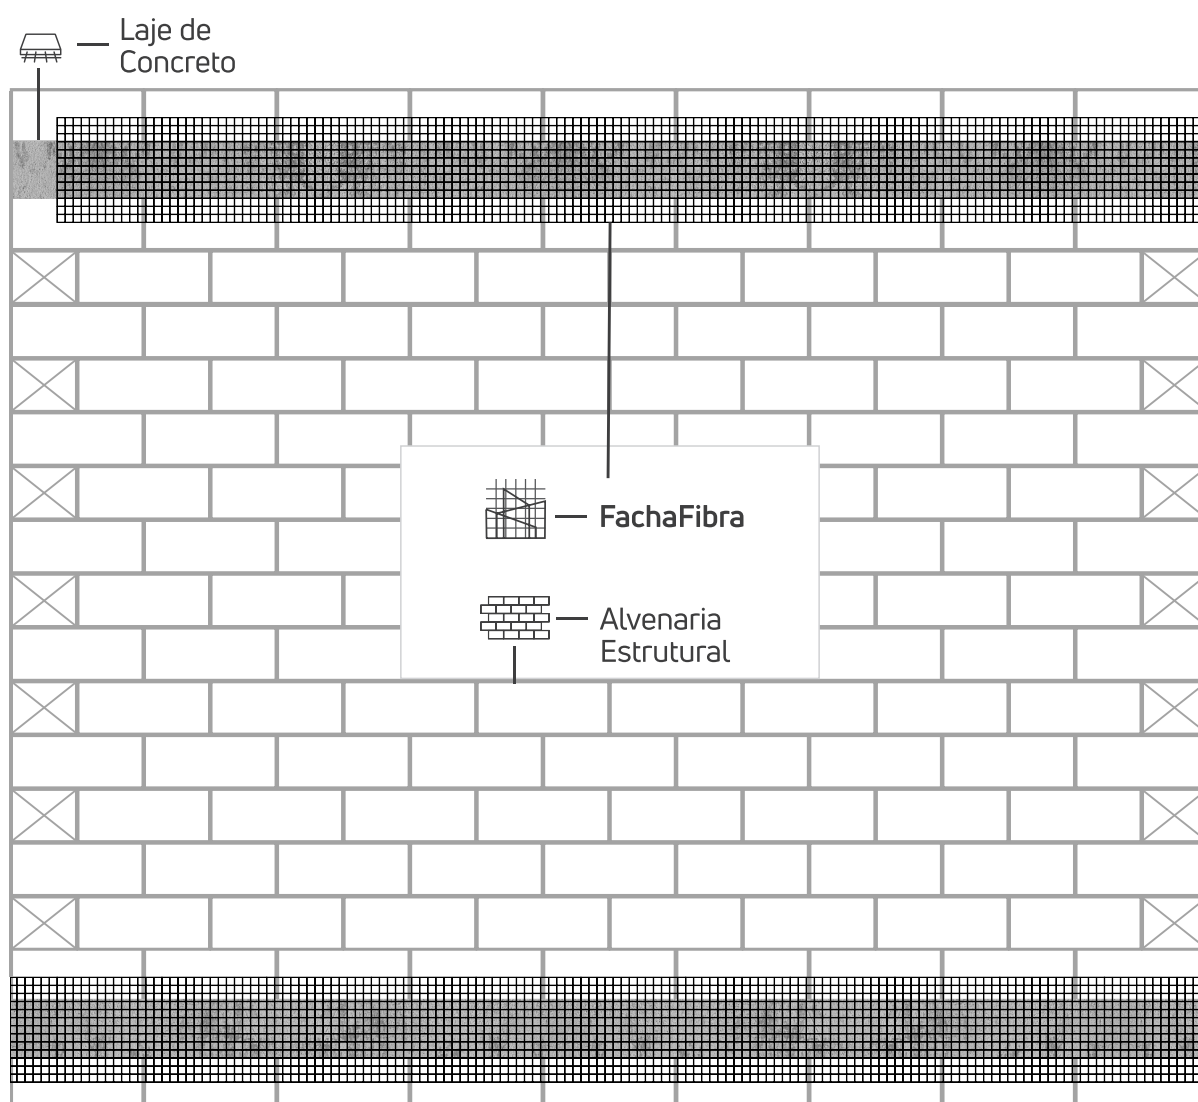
Posicionamento da FachaFibra para reforço do revestimento de argamassa nas interfaces entre alvenaria estrutural e laje de concreto armado
